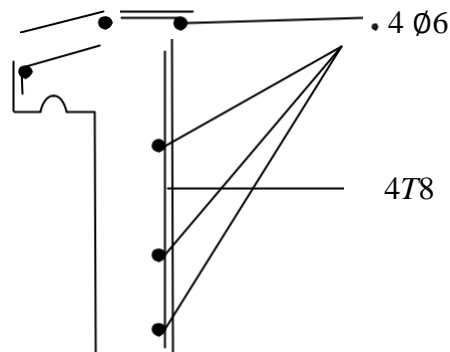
Schéma de ferrailage de l'acrotère
